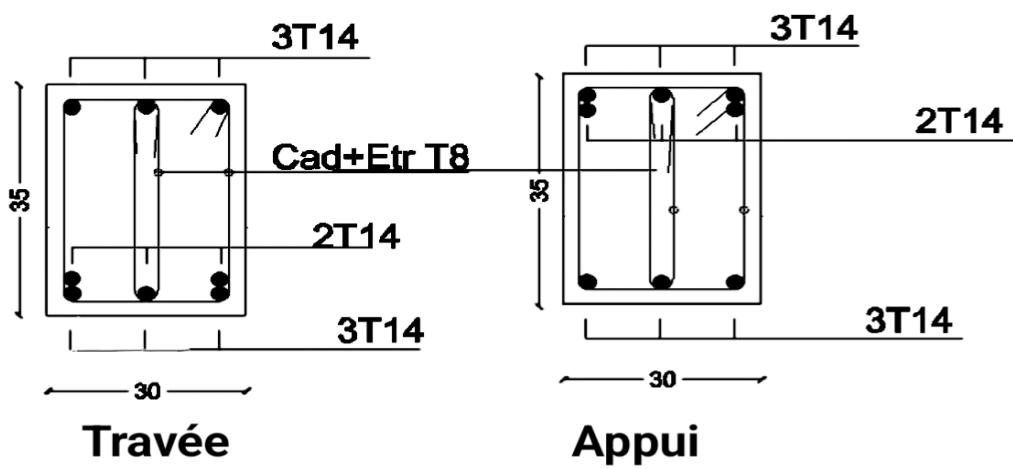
Ferraillage des poutres secondaires du Terrasse.
